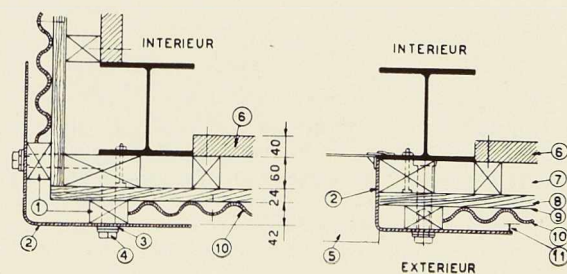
Détails constructifs de la façade de la tour d'essais.
